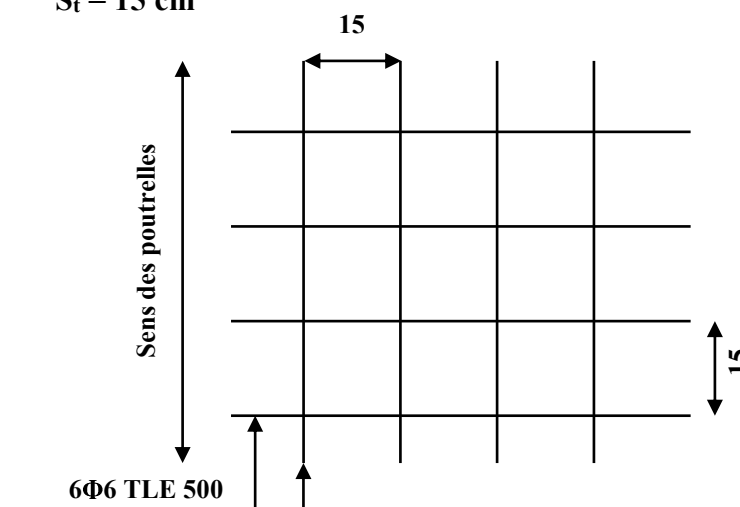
Ferrailage de la dalle de compression avec un treillis soudé 15x15cm
